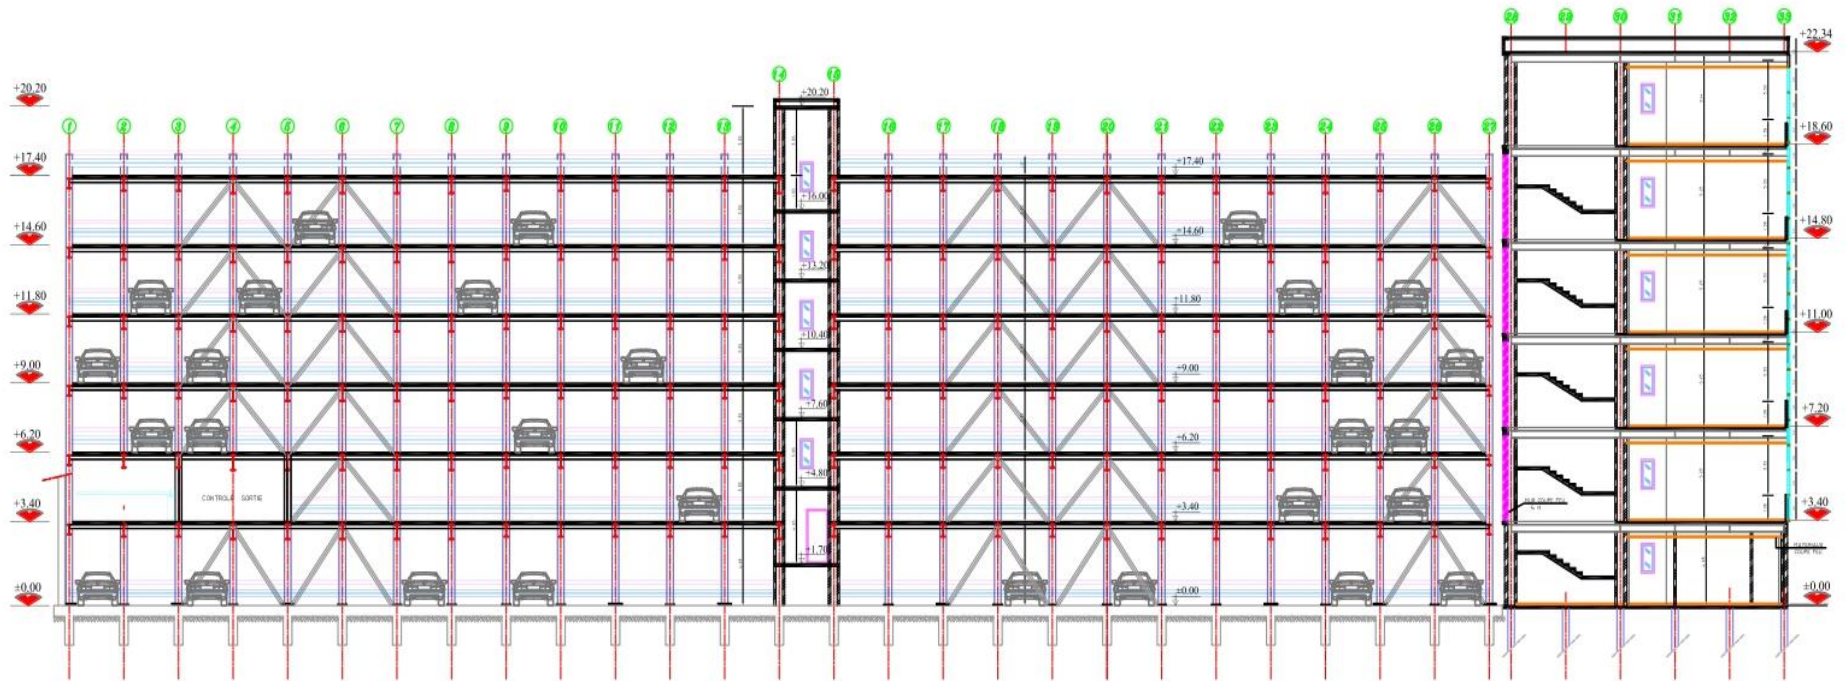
Plan d'architecture (Coupe B-B) [Autodesk AutoCAD 2023]
